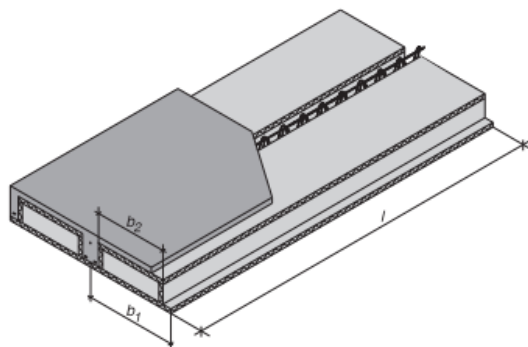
Orientační rozměry železobetonových trámových stropů (zdroj: [1])
